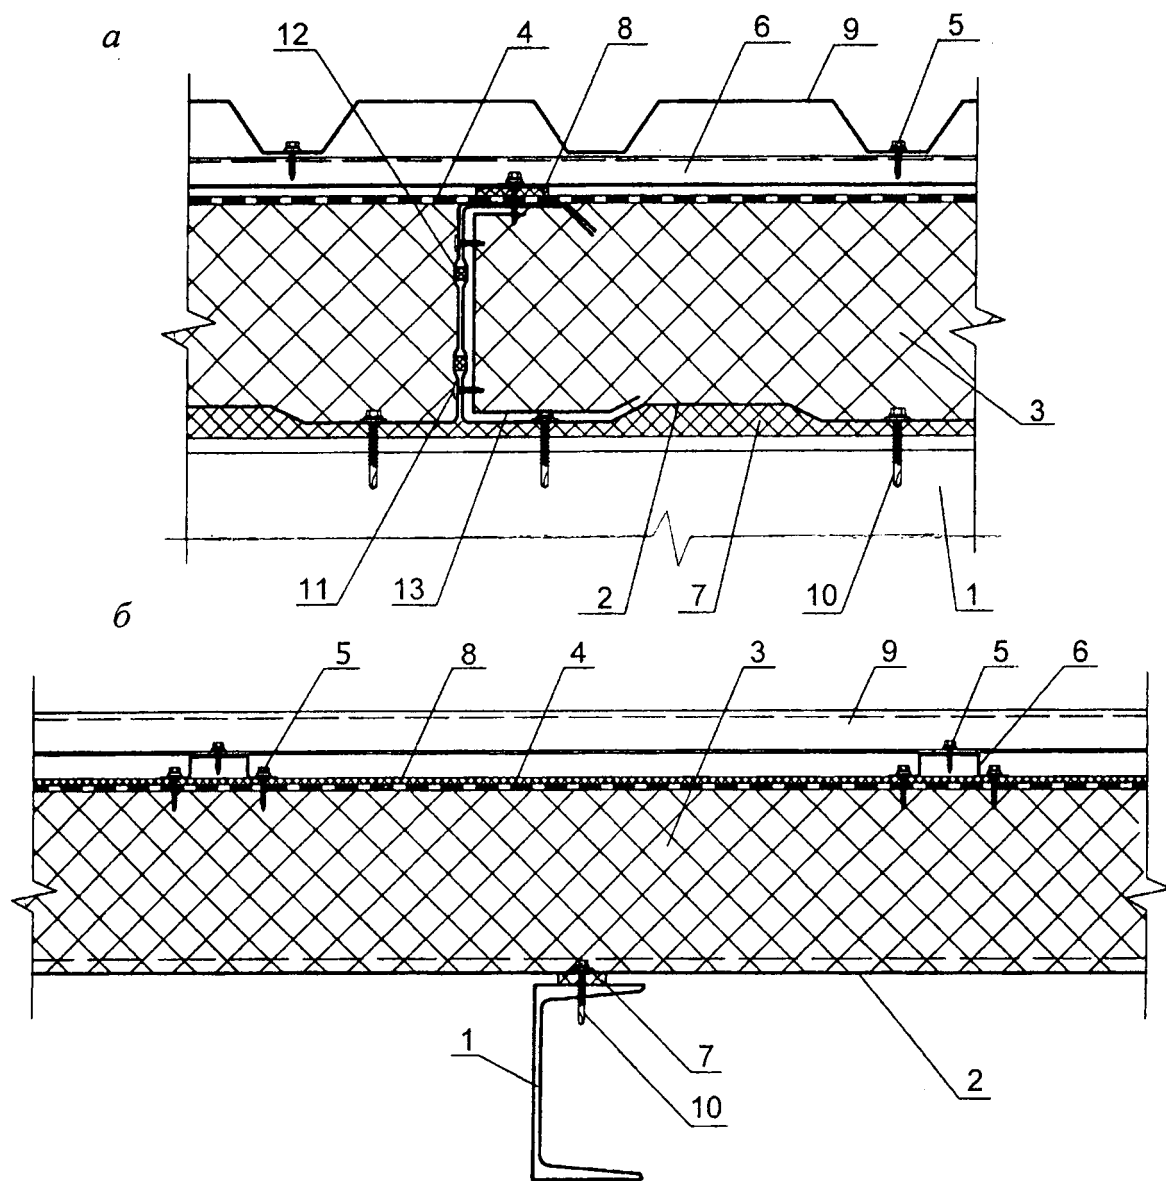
Кровельные панели поэлементной сборки без дополнительного утепления:
